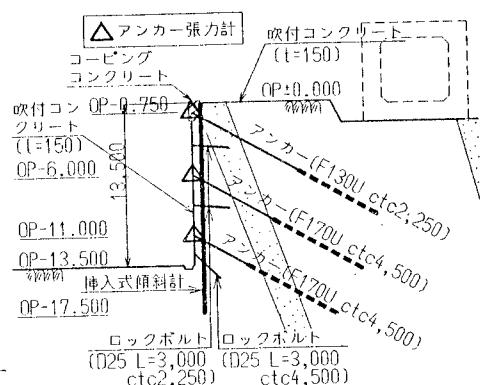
岩盤直掘工⑧-⑧断面図(S=1/500)
